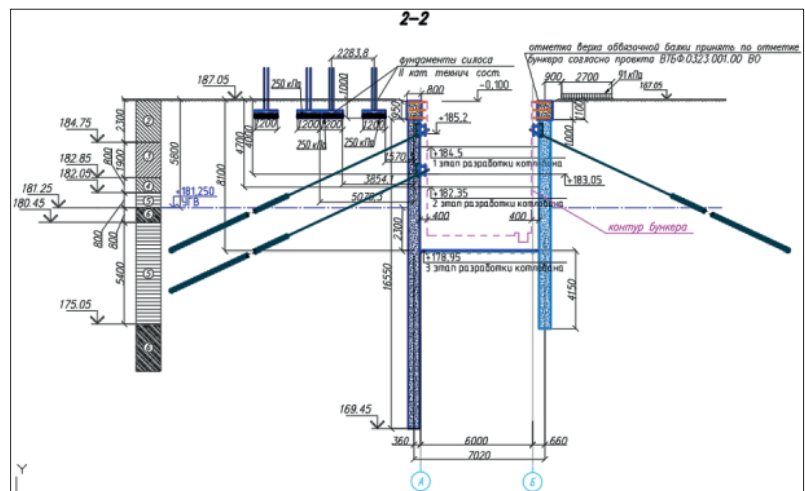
Схема вертикальной привязки заглубленных удерживающих конструкций строительного котлована
